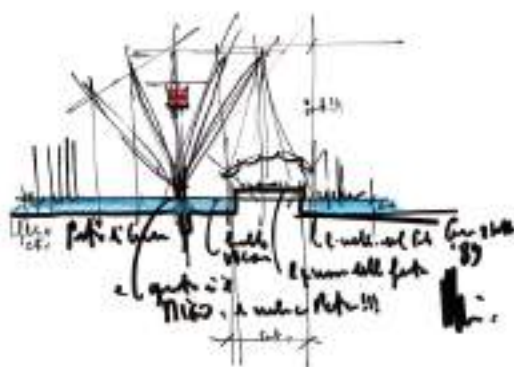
Esquisso do “Porto Antico” de Renzo Piano de 02/09/1989. Fonte: Fondazione Renzo Piano
